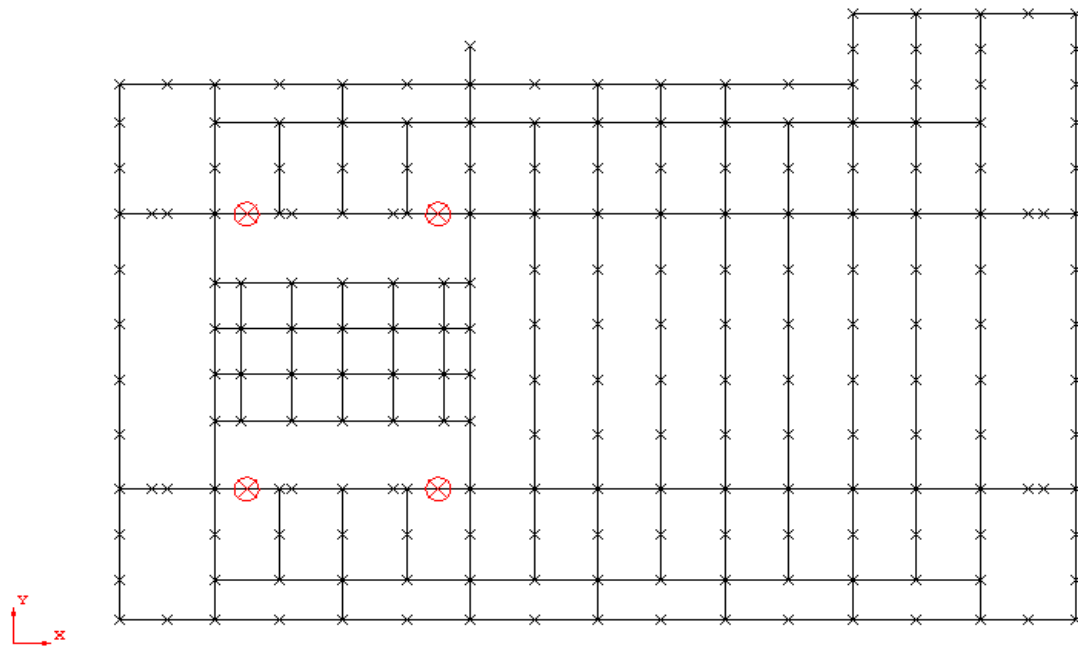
TORRE DE PERFORACIÓN – CARGA DE BARRENA – APLICACIÓN DE CARGA CUBIERTA SUPERIOR.
